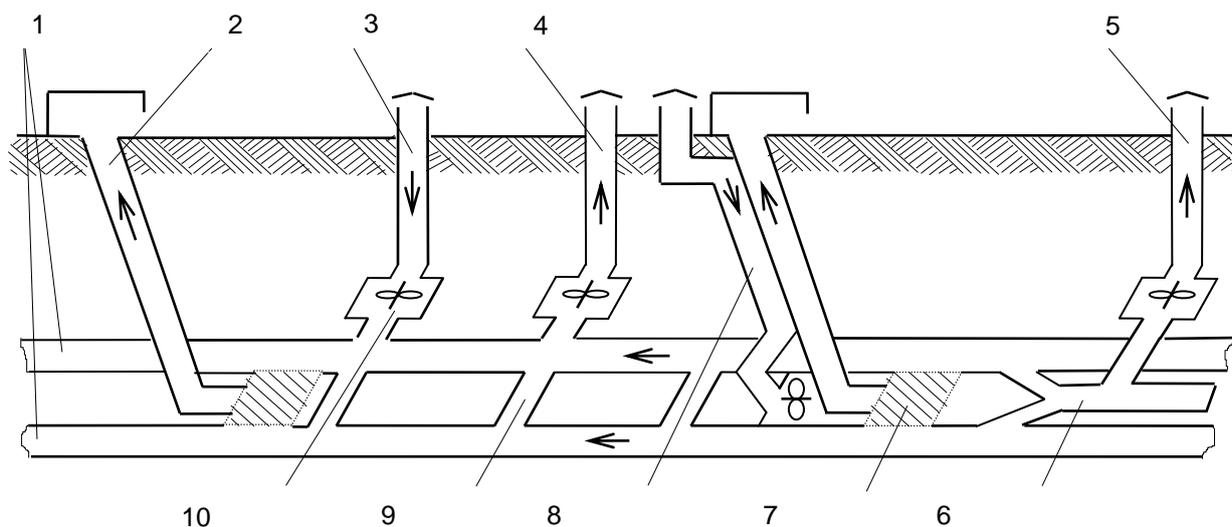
Схема тоннельной вентиляции участка метрополитена:
